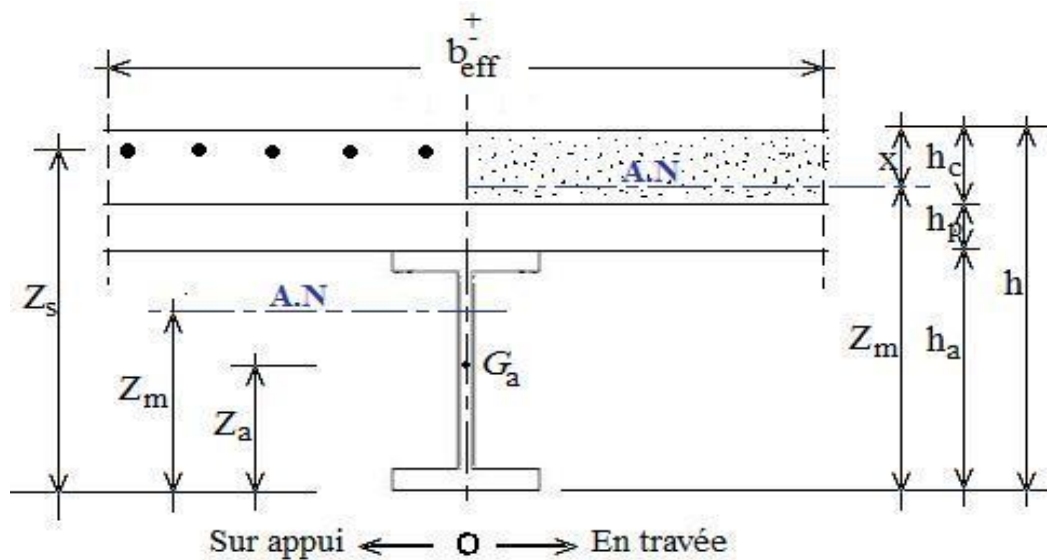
Notations et conventions adoptées pour une section mixte en travée et sur appui.
